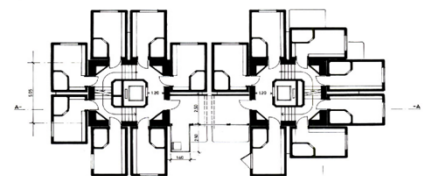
Recuperada de: <http://moleskinearquitectonico.blogspot.com/2011/09/kurokawa-nakagin-capsule-tower.html> Planta de las torres donde se puede ver que, al extraer dos cápsulas de ajuste por planta, esto permite la libre disposición y orientación de las mismas en los dos sentidos, provocando la heterogeneidad del conjunto.
